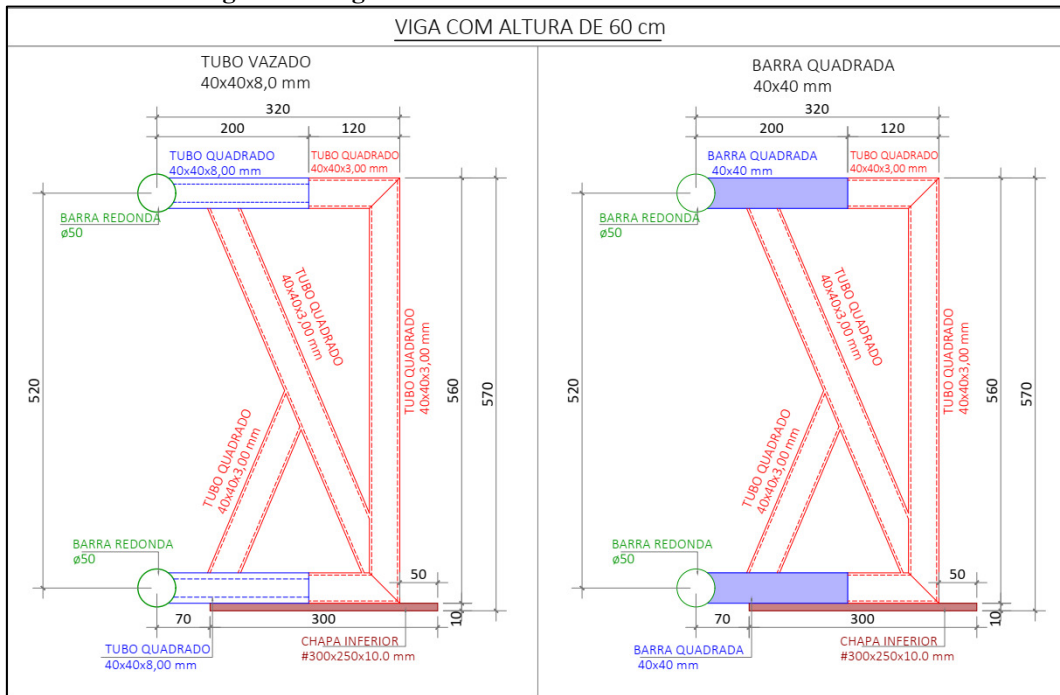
Viga 30x60 - Tubos e barras metálicas de 60 mm
